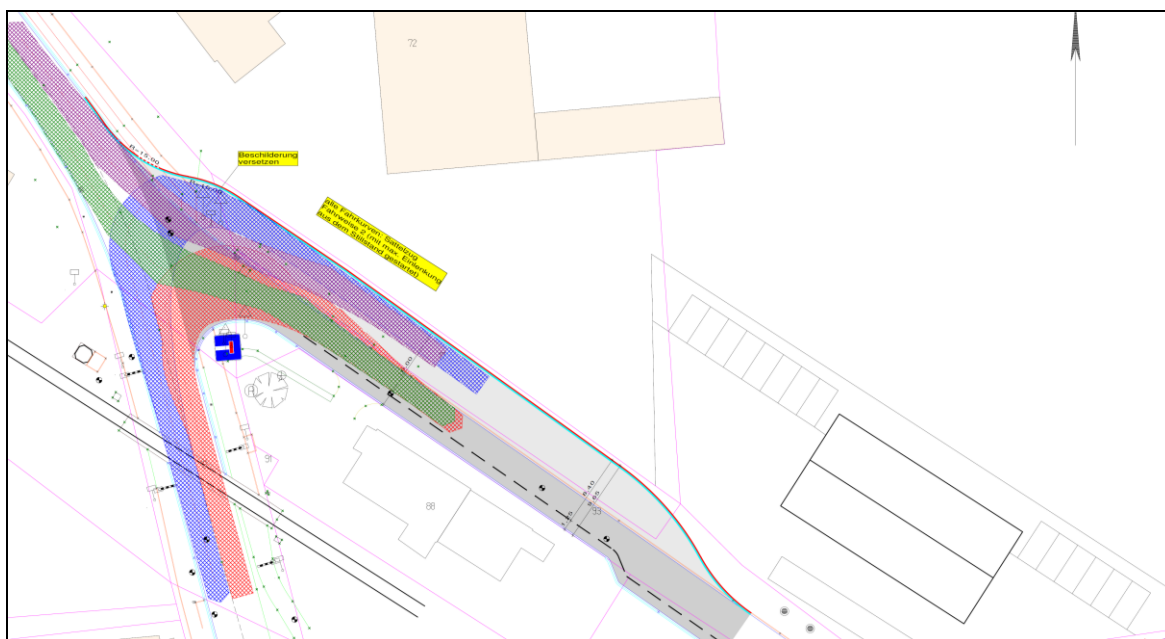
Knotenpunkt West, Lageplan mit Schleppkurven, Ing.-Büro Gnegel, Sendenhorst, Mai 2013 (genordet, verkleinert, o.M.)
